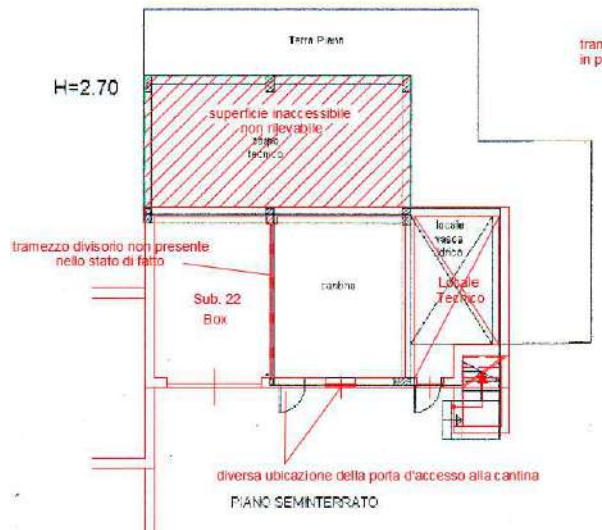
Sovrapposizione delle planimetrie di rilievo con la planimetria catastale relativa al piano seminterrato
